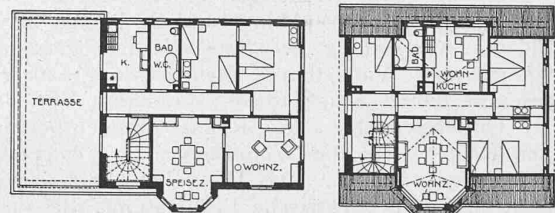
Grundrisse des Dreifamilien-Wohnhauses Thoma, mit Laden- und Werkstatt-Anbau. — Masstab 1 : 400.
